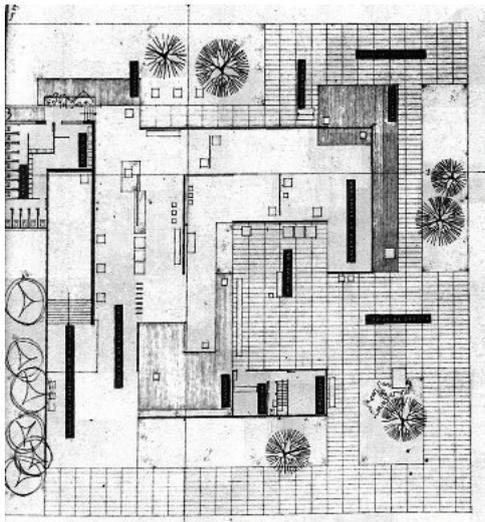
Planta de acceso de la propuesta del concurso para construir el Pabellón Español en la Bienal de Venecia XXVIII, 1956.
